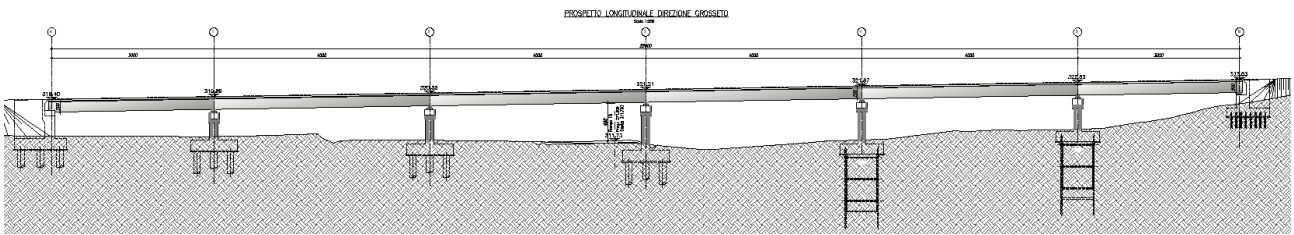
Profilo longitudinale carreggiata direzione Grosseto.
